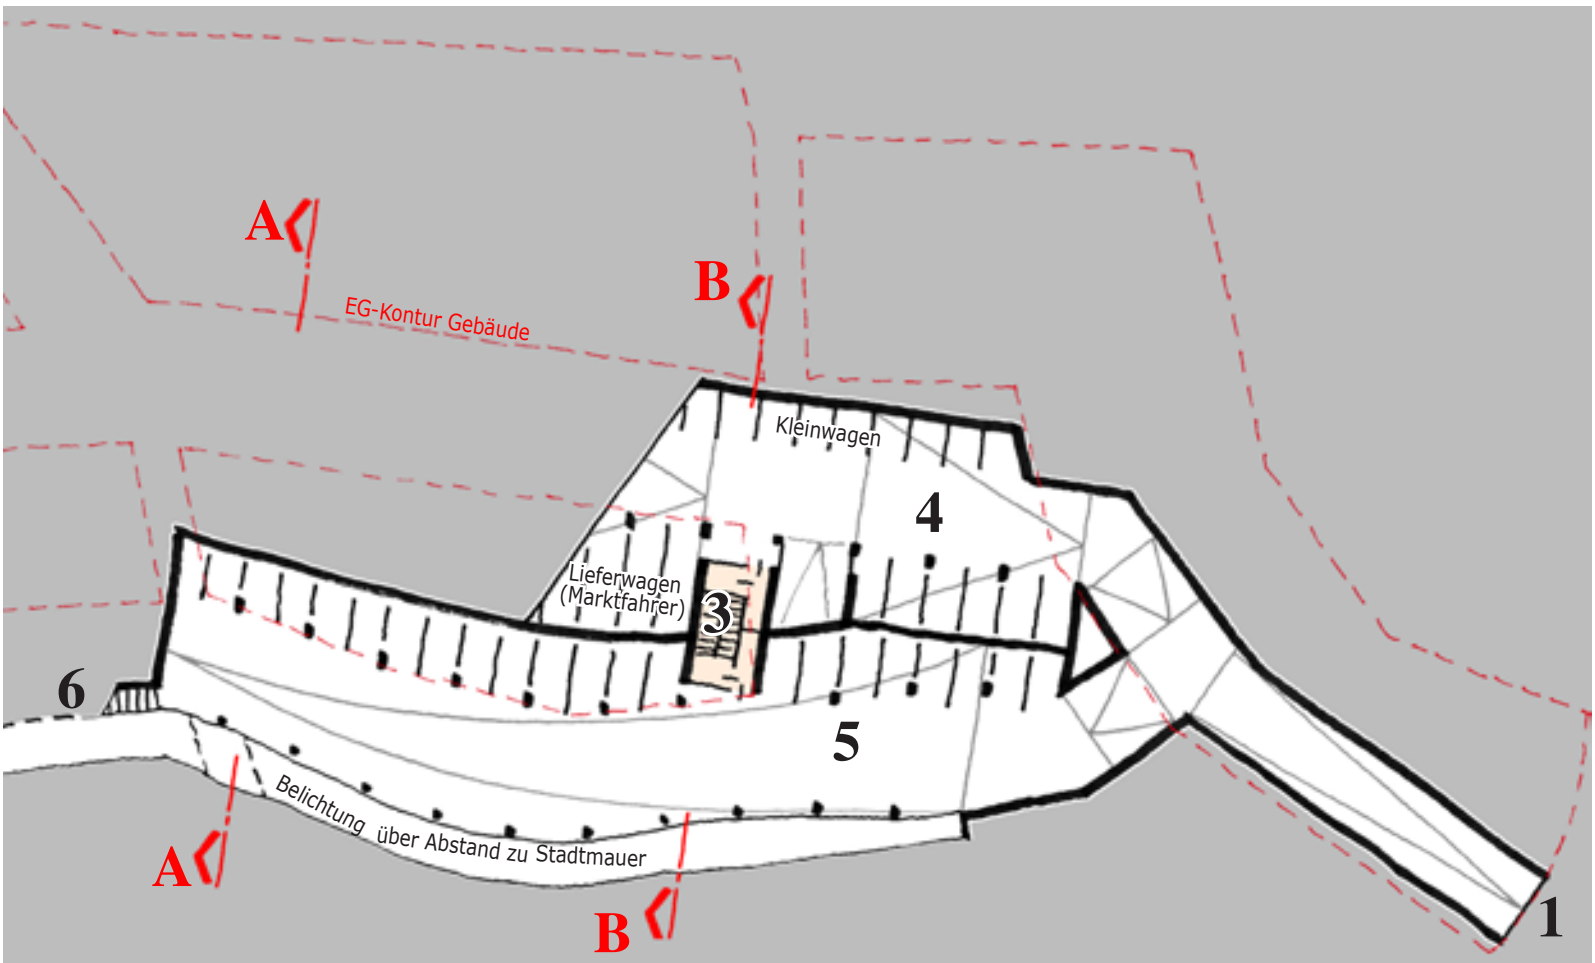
Tiefgarage Grundriss UG1; M1:500
